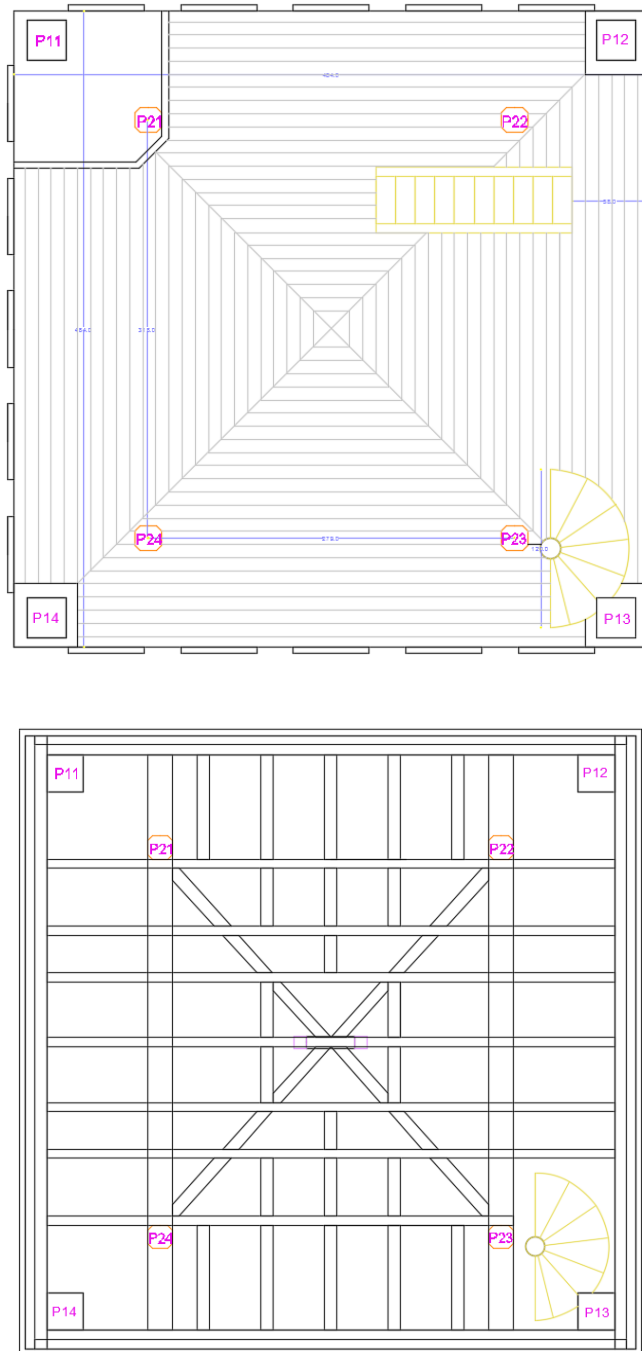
12 Planta estructura segundo nivel Torre del Reloj de Iquique
